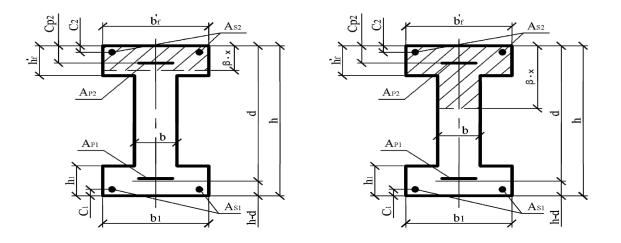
Формы сжатой зоны железобетонных элементов двутаврового сечения при расположении границы сжатой зоны в полке (a) и в ребре (б).
